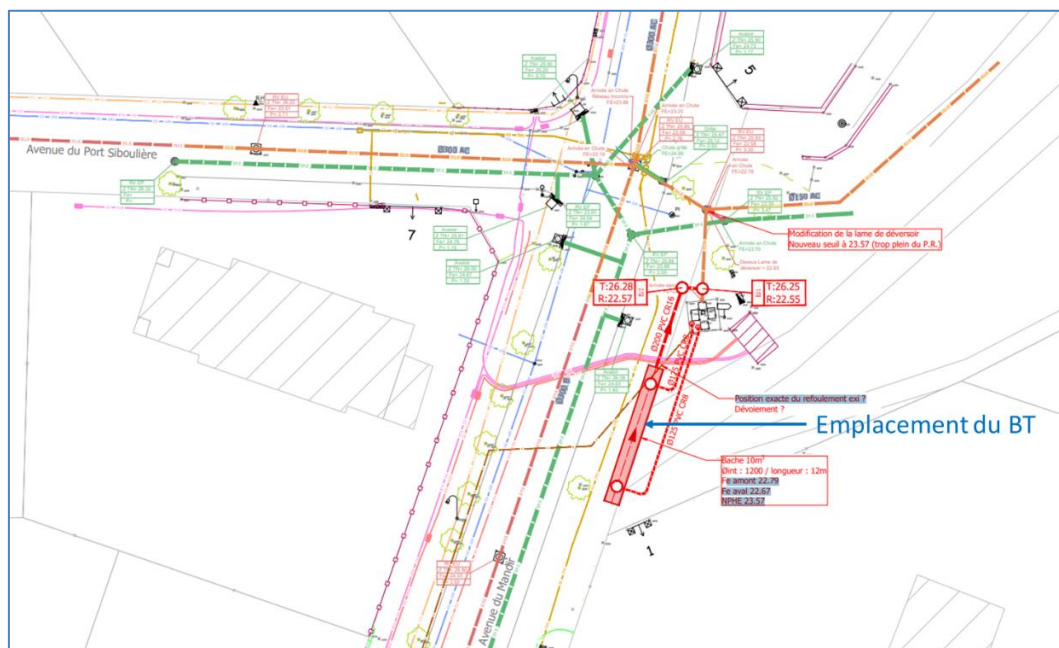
Extrait du plan PRO d'aménagement du bassin tampon de Beauvallon (source : VEOLIA)
